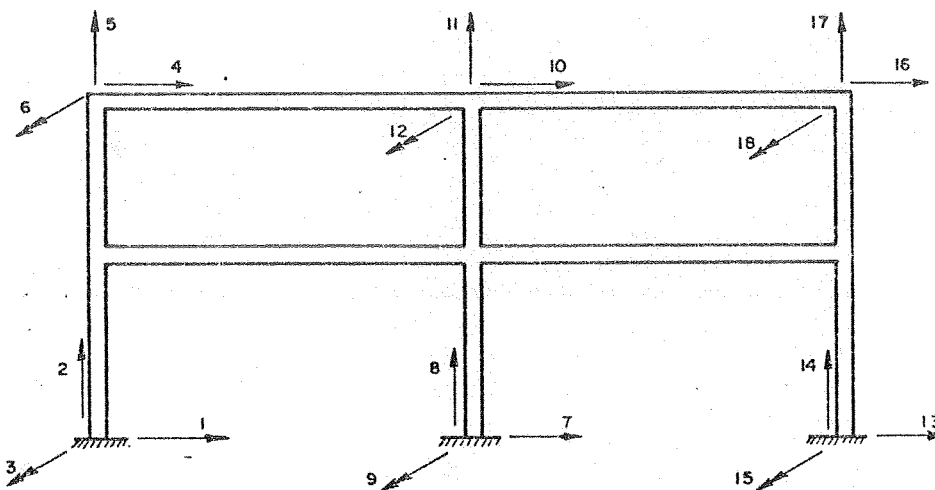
SUBESTRUTURA S DE UMA ESTRUTURA.
